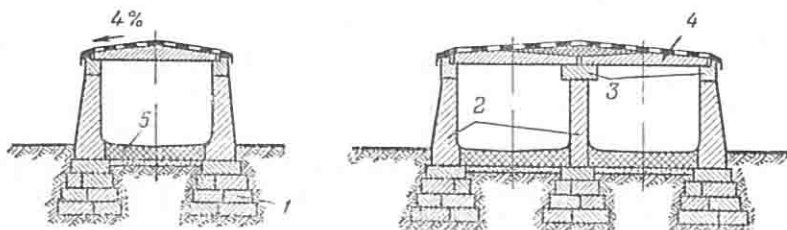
Прямоугольные блочные бетонные трубы с плитным железобетонным перекрытием отверстием 2,0–6,0 м; разрез по звеньям одноочковой и двухочковой труб:
